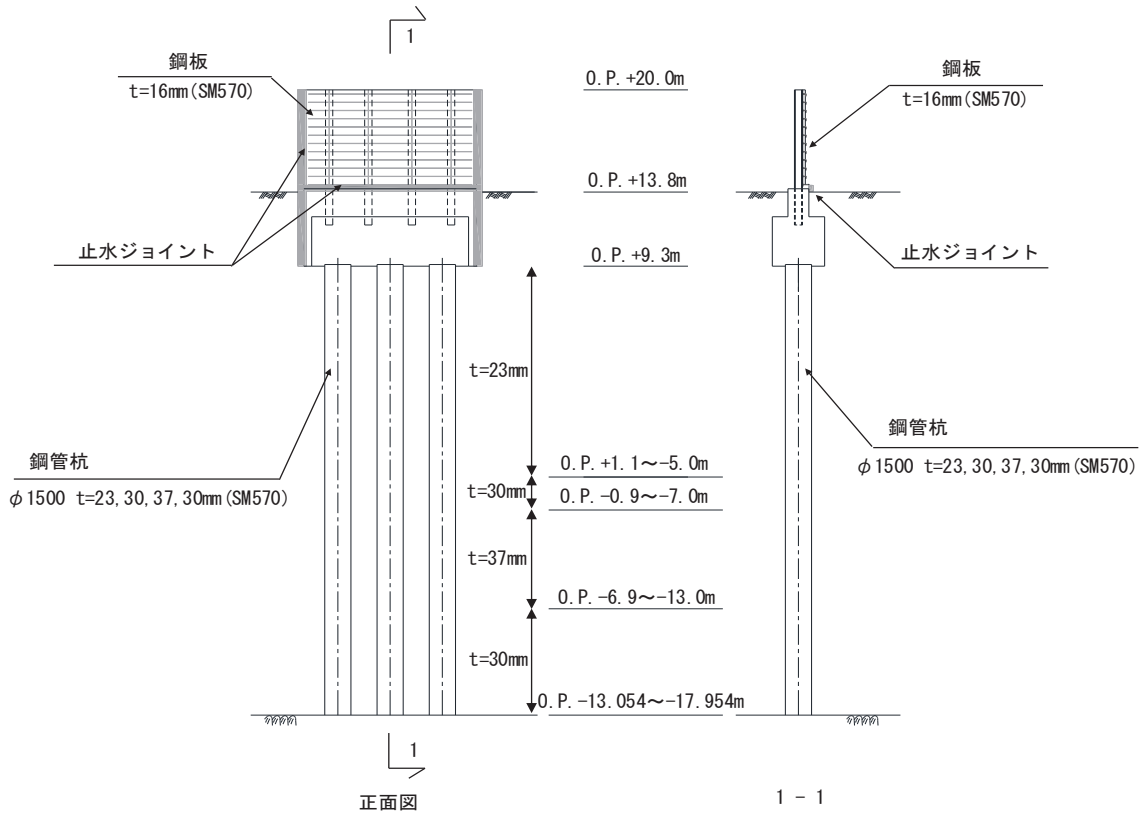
鋼製遮水壁（鋼板）の構造図（正面図及び断面図：I 区間）
